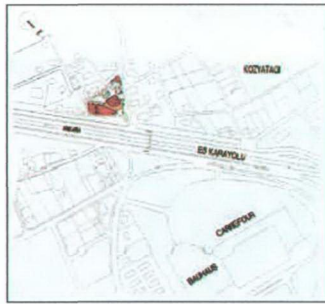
Koz. İş Mer. Vaziyet Planı
